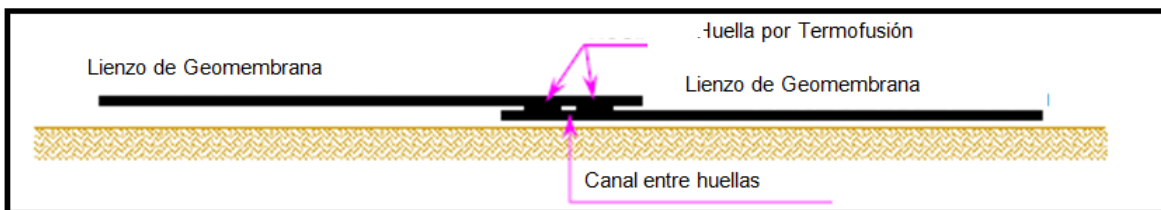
Soldadura de lienzos de Geomembrana
